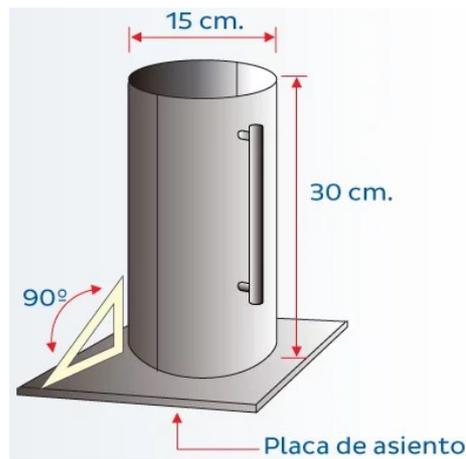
Molde tipo para probetas de Hormigón. – Fuente: (Romo Proaño, 2010)
